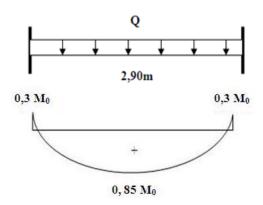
diagramme de la poutre palière à la flexion E.L.S.
